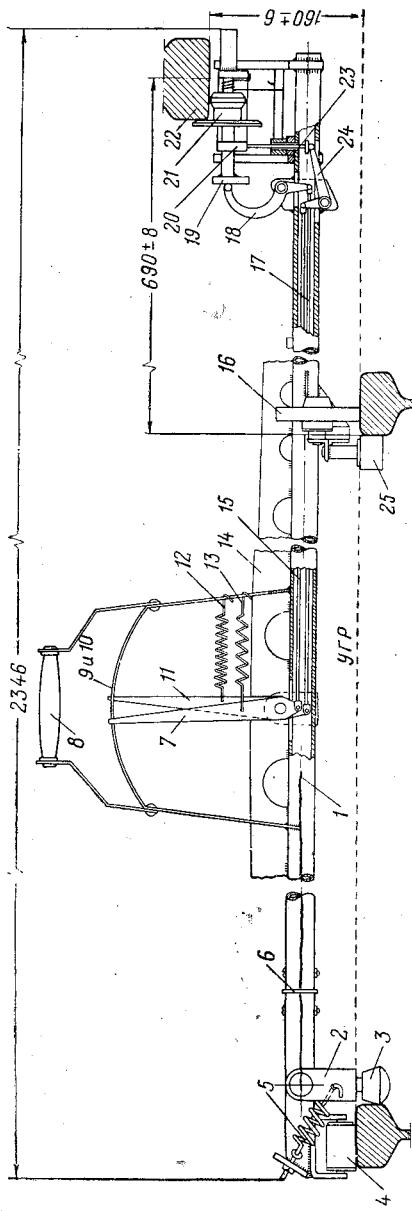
Катучий шаблон для проверки положения контактного рельса:
